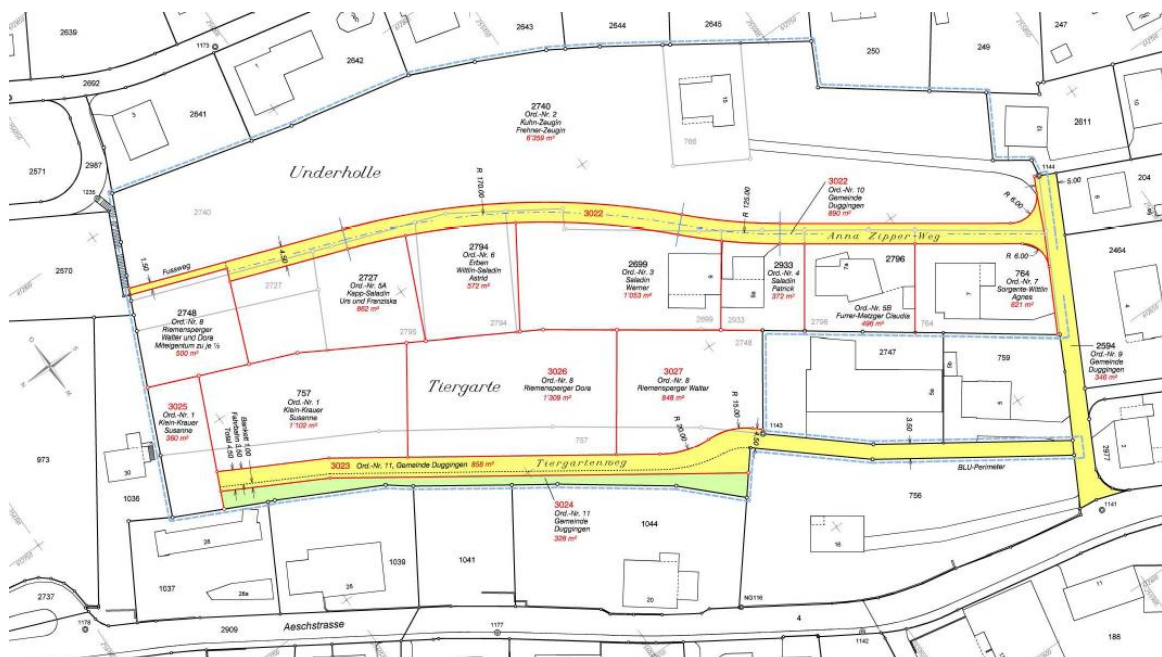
Neuer Bestand mit Erschliessungsstrassen und daran angepasster Parzellierung
